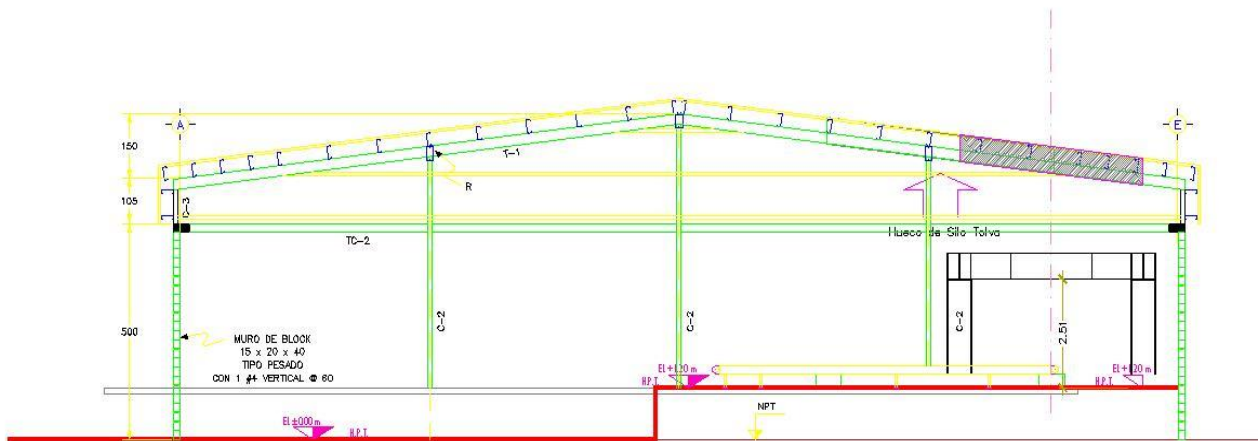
PLANTA ARQUITECTONICA BODEGA DE ENSACADO
